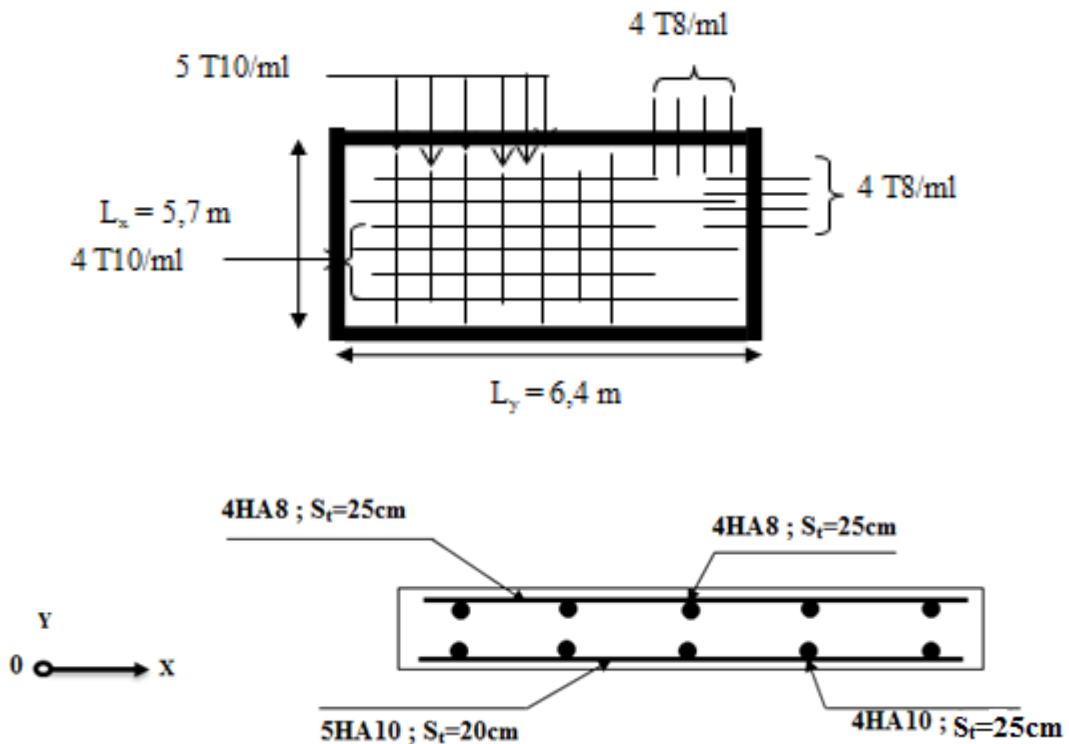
Ferrailage de la dalle pleine sur 04 appuis (type 02).
